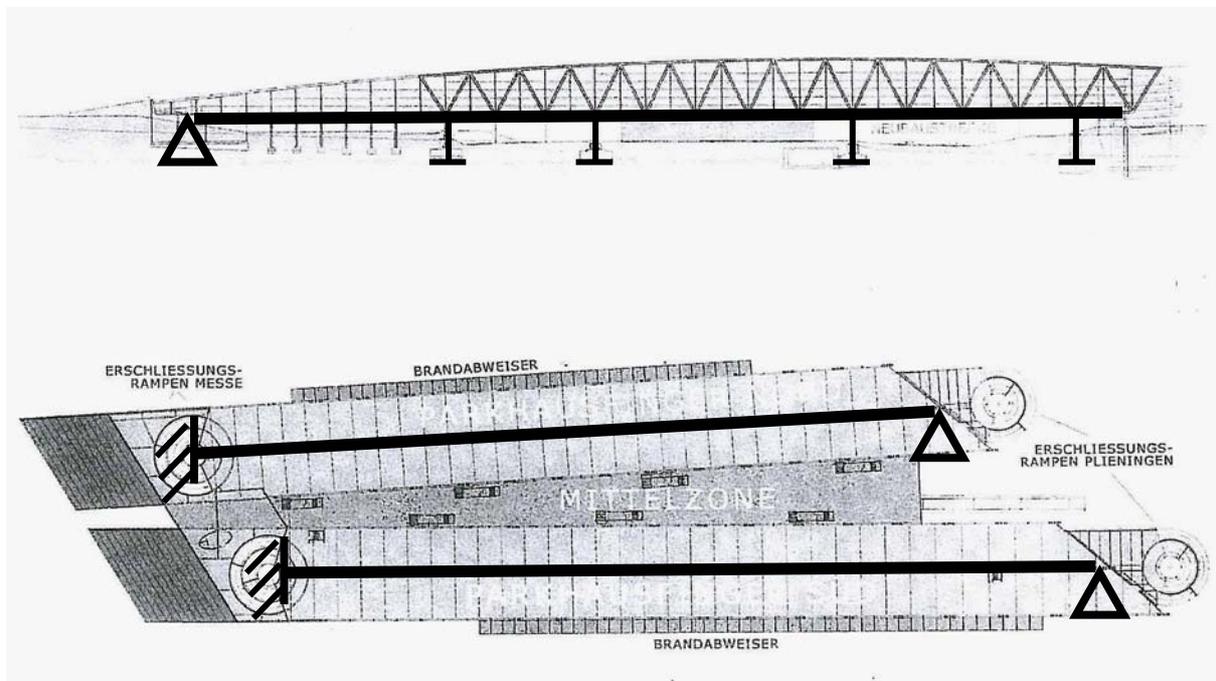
Vertikales und horizontales statisches Systeme des Endzustandes
